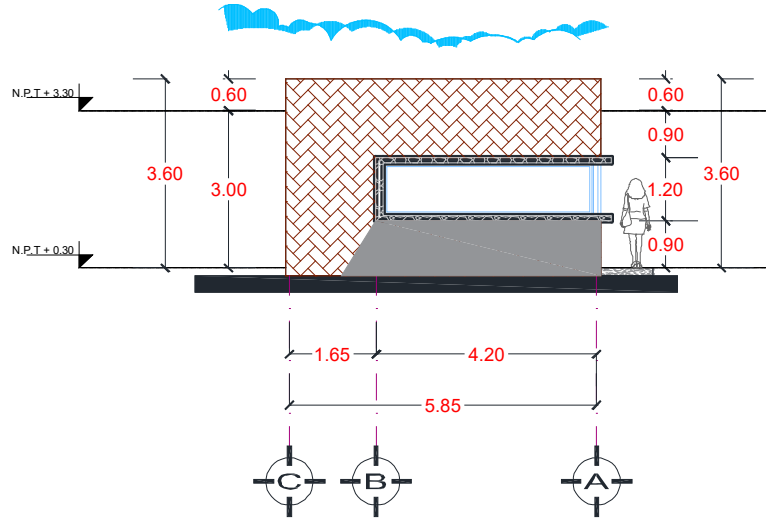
Propuesta Caseta de Vigilancia, Fachada Noroeste (Anexos Plano: 7- FACH-CASETA-01)
